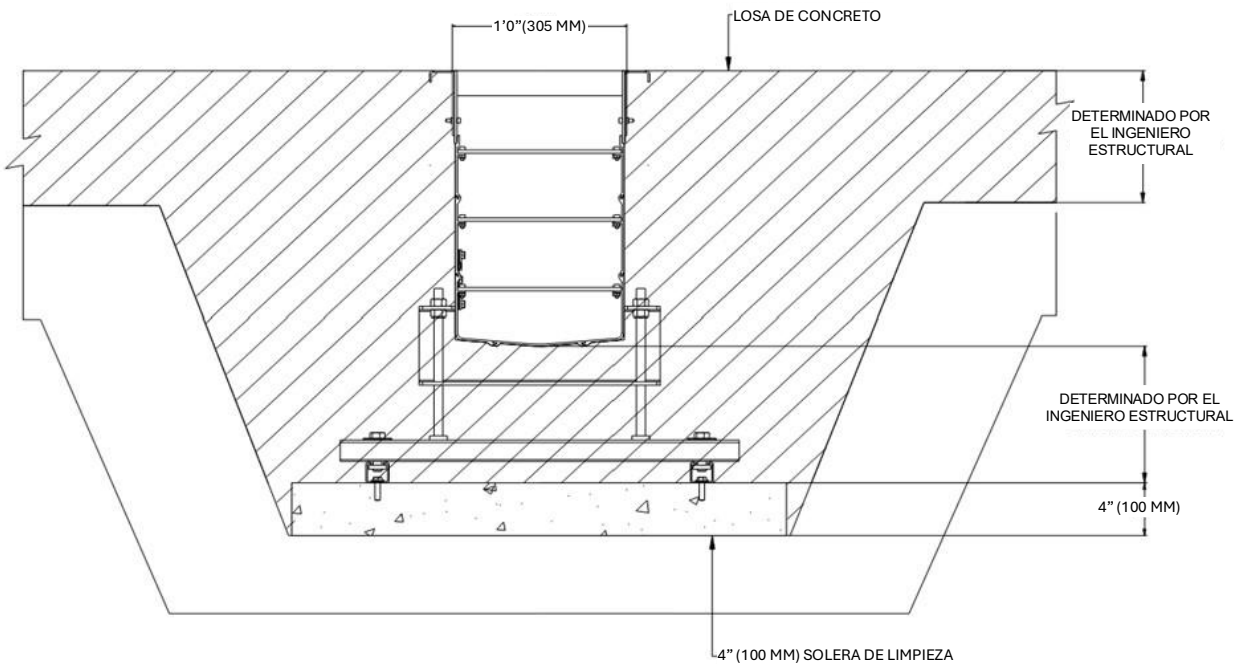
Diseño de losa con zanjas prefabricadas de aluminio
